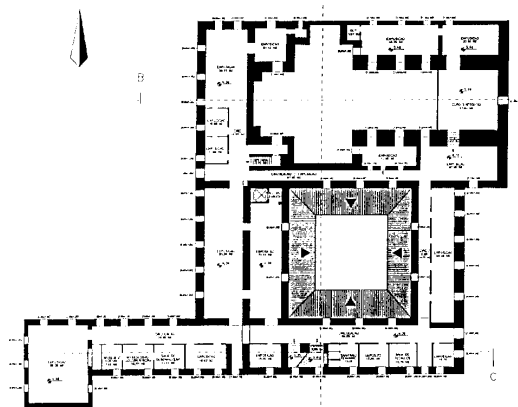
Planta baixa do segundo pavimento do Museu de Arte Sacra da UFBA.
